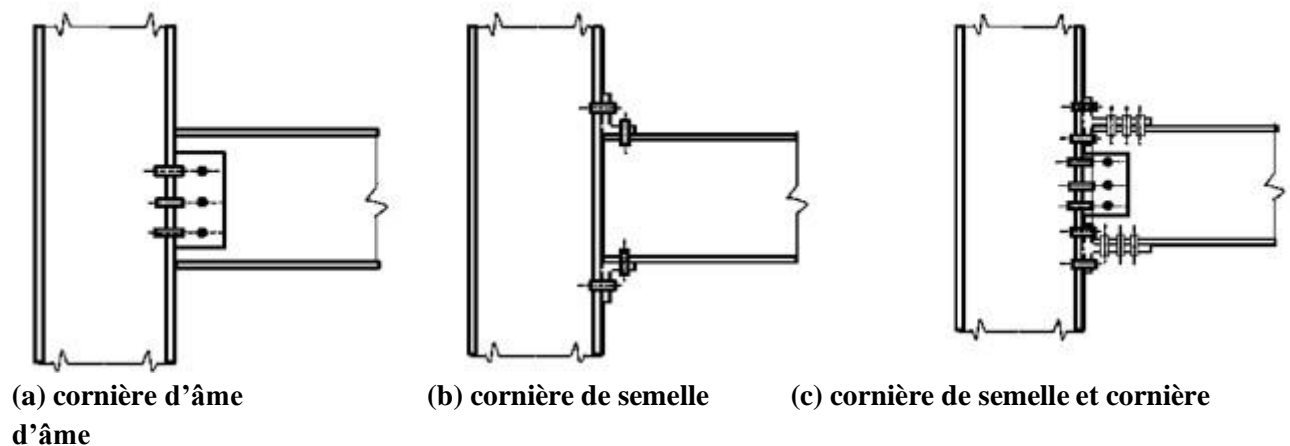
Assemblage poutre-poteau par cornières d'âme et/ou des semelles.[14]
